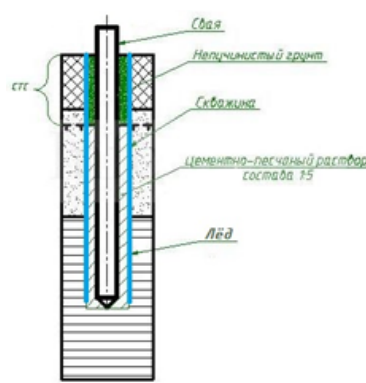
Буроопускная свая со льдом между раствором и грунтом
